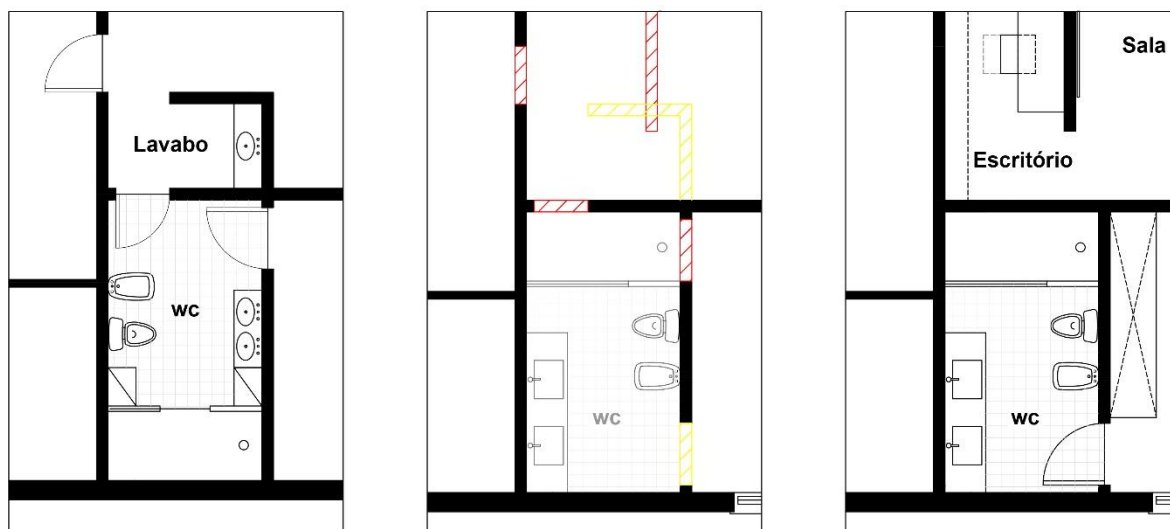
Pormenor da casa de banho da suite: planta do cliente, planta de demolição e planta de proposta.
